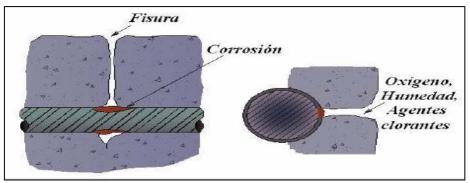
Influencia de las fisuras en la corrosión de las armaduras. (Stuardo, K. 2008).
